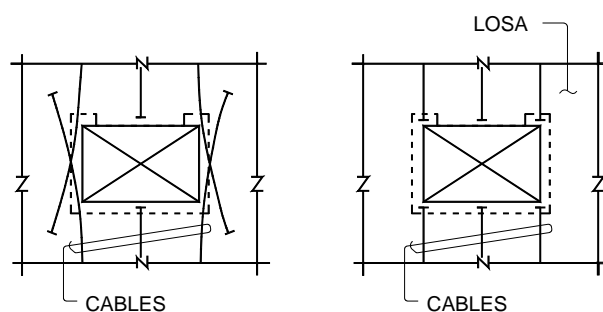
Disposiciones de los cables: (a) Inhibidora de la fisuración; (b) favorecedora de la fisuración
